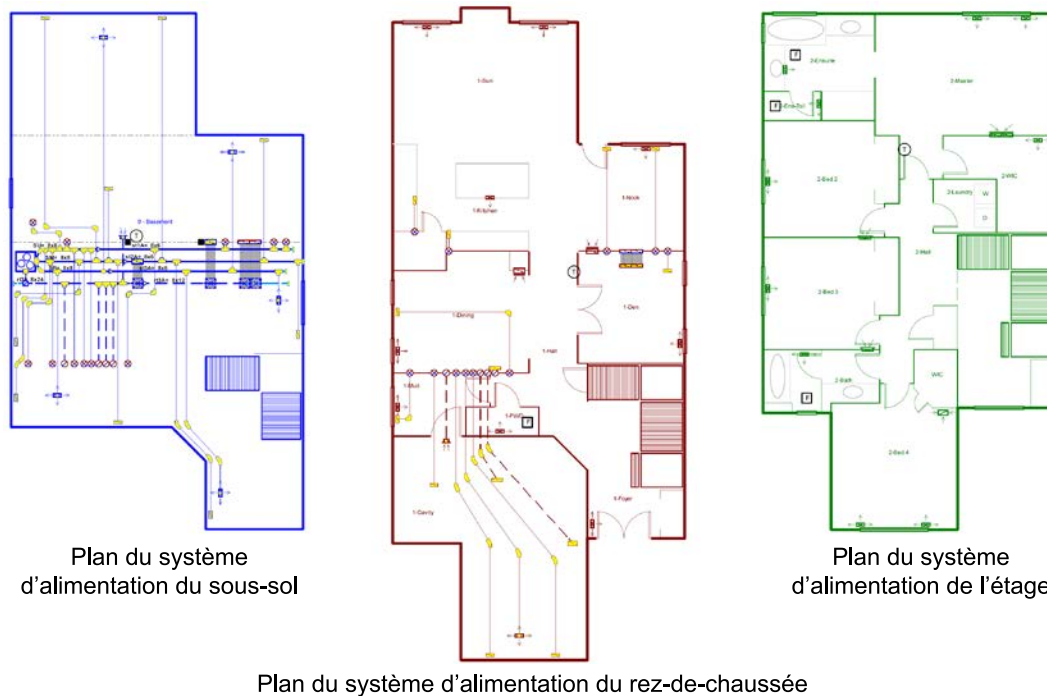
Plan des conduits d'alimentation de l'exemple de concept des conduits par zone
